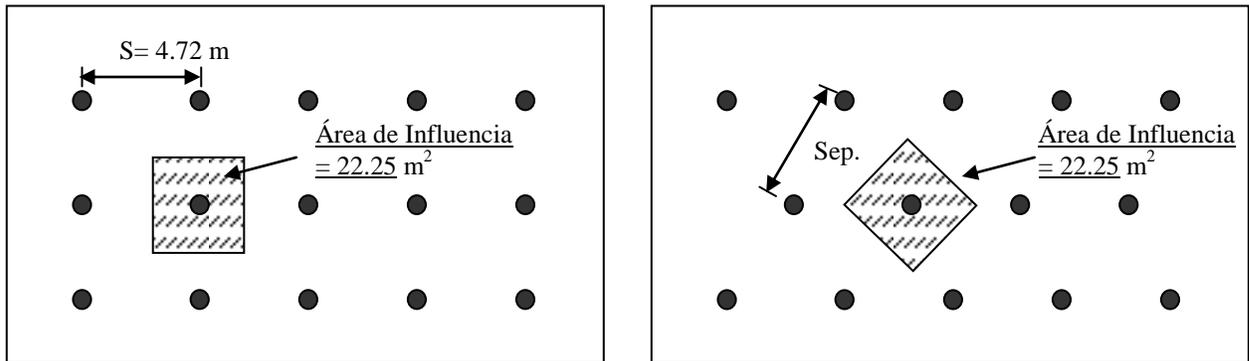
Patrón de anclaje normal y patrón de anclaje en tres bolillo
